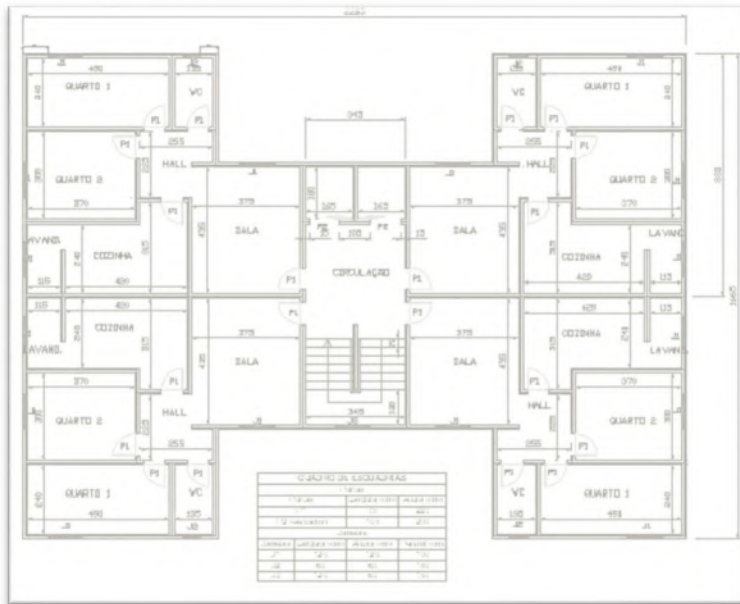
Planta baixa do pavimento tipo em Concreto Armado
